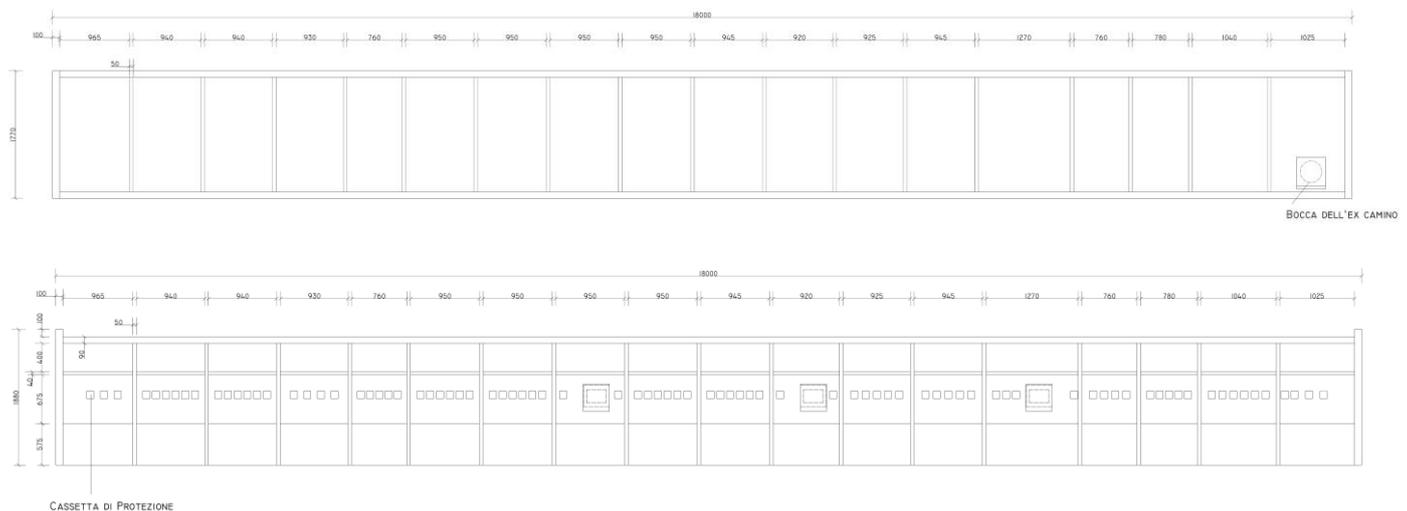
Forno di ricottura. Schema planimetrico e prospetto principale.
